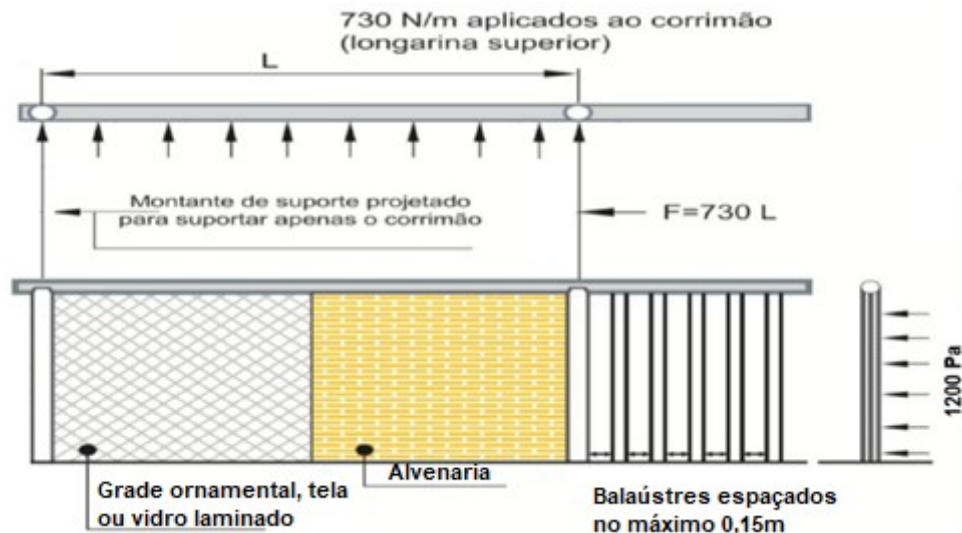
Pormenores construtivos da instalação de guardas e as cargas a que elas devem resistir
